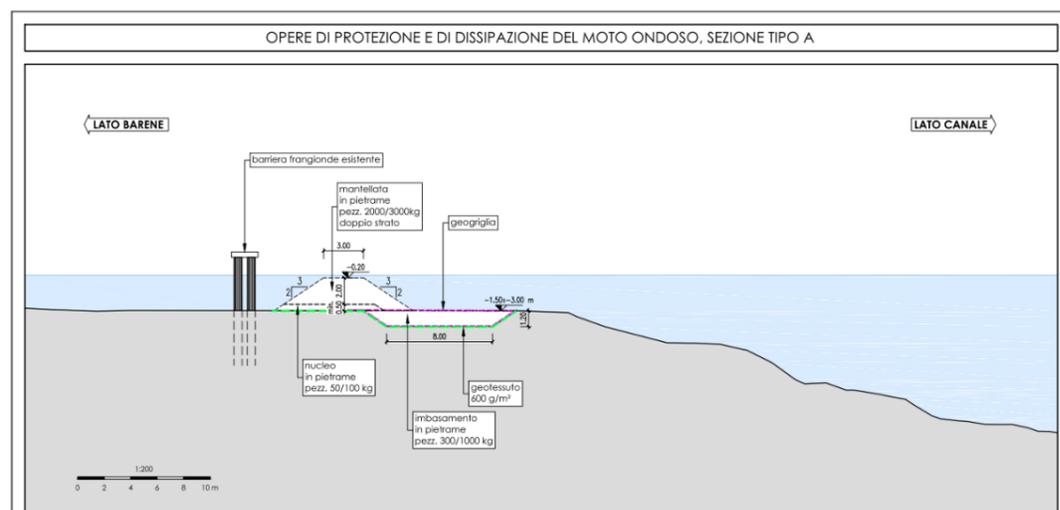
opere di protezione e dissipazione sezione tipo A
